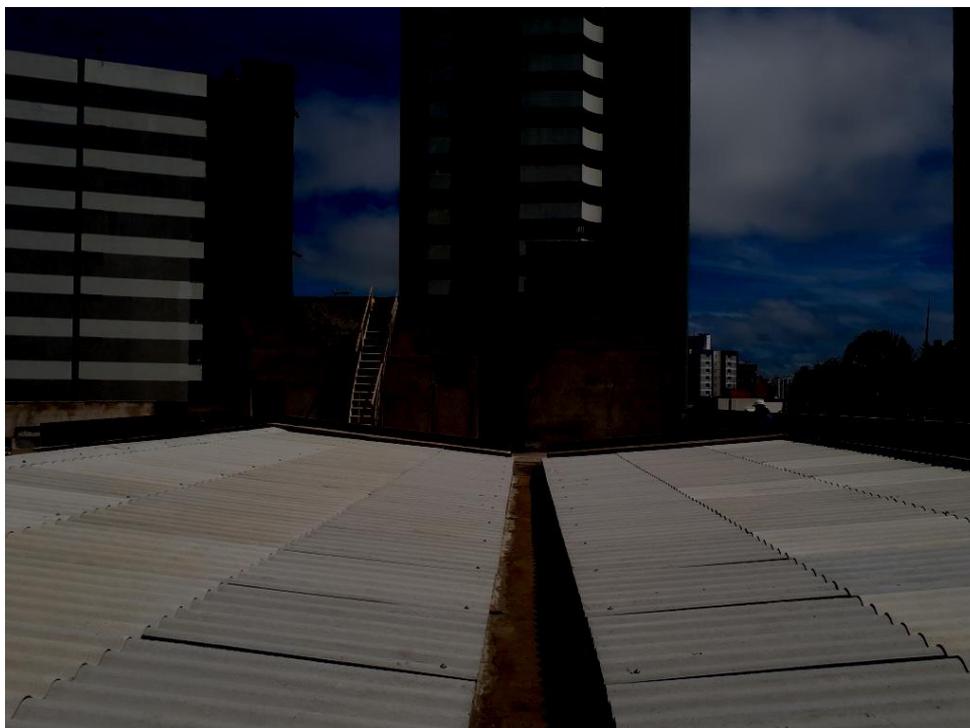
Vista geral da laje de cobertura. Ao fundo laje do barrilete e reservatório concretados.
